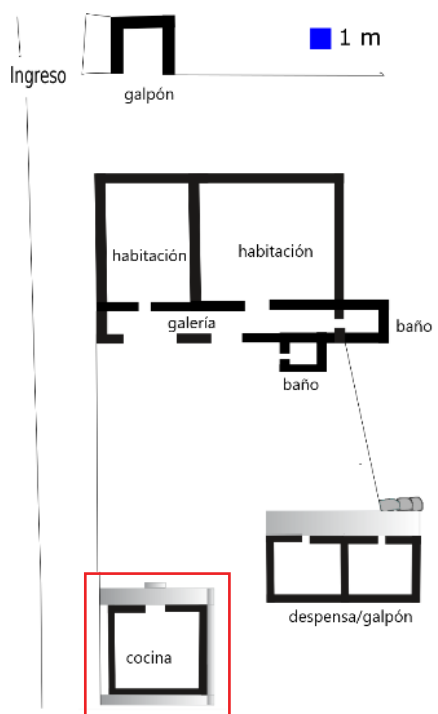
Planimetría del puesto de Oca. Se observa la disposición del conjunto en torno a un patio central. Se destaca en rojo, la estructura más antigua del conjunto.
